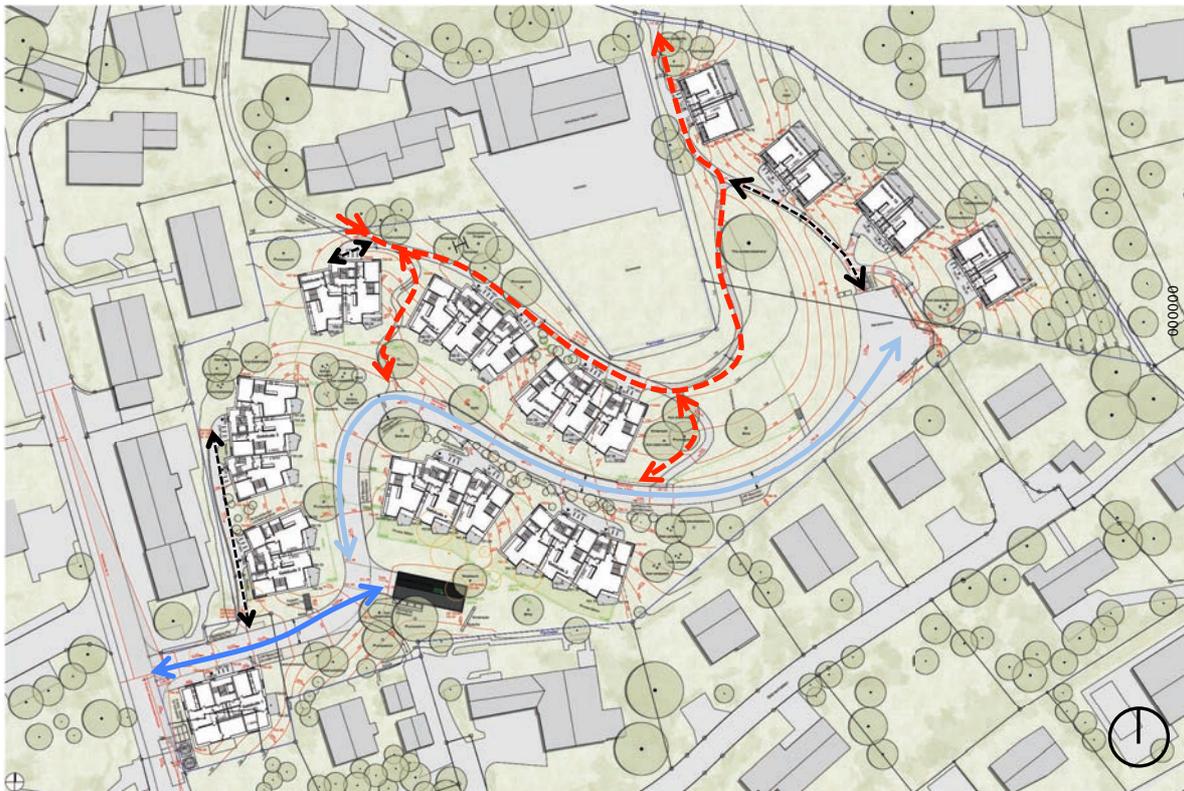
Erschliessung mit Anschluss an die Dorfstrasse, Abschnitt bis Garageneinfahrt (dunkelblau), Abschnitt bis Häuser 9 bis 12 (hellblau), öffentliche Fusswegverbindungen (rot); interne Fusswegverbindungen (schwarz)
